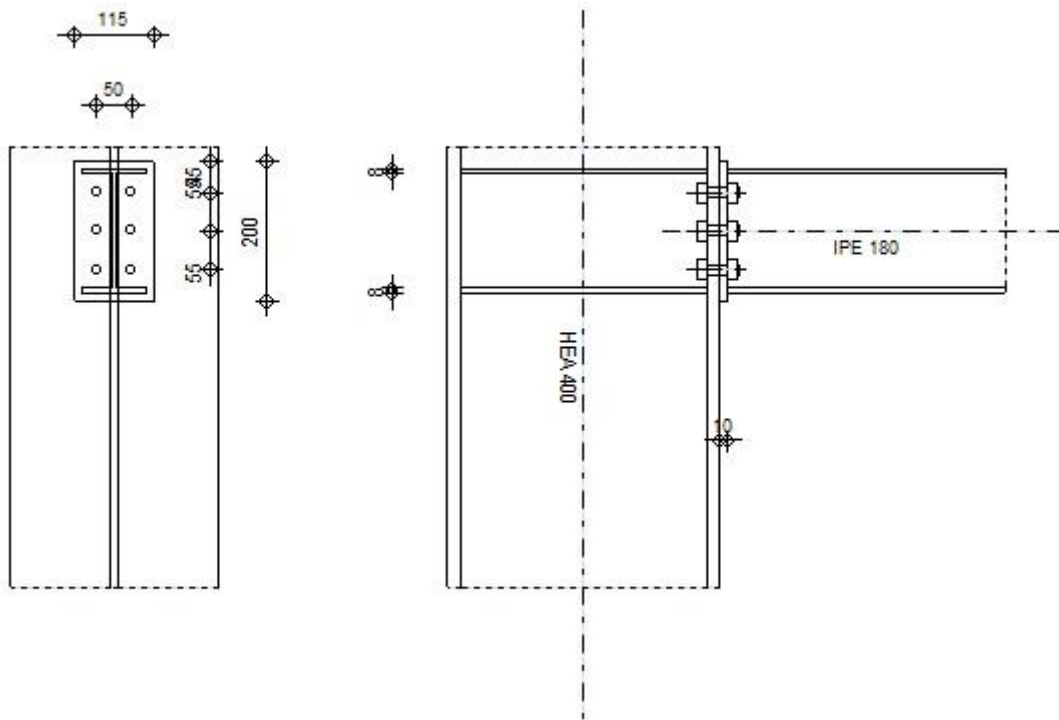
Détail sur l'assemblage poutre secondaire-poteau
